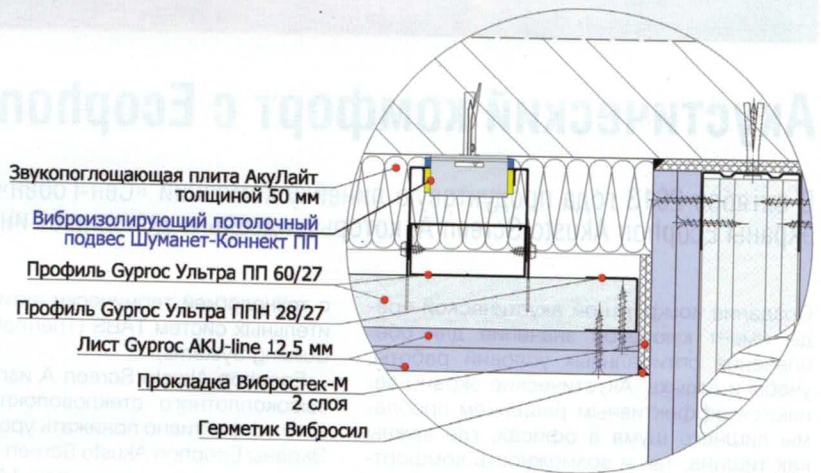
Узел крепления конструкции подвесного потолка к перекрытию
